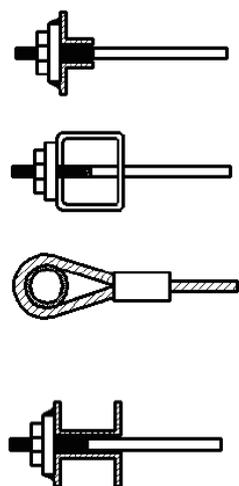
Анкерное крепление вантовых канатов к металлическим конструкциям насквозь
